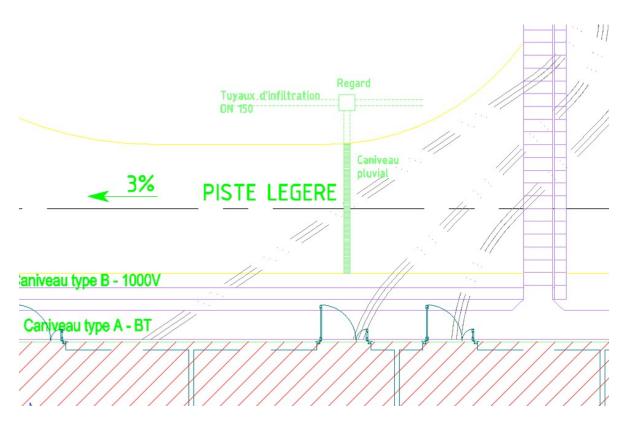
Principe de mise en place de caniveau en pied de rampe de piste
